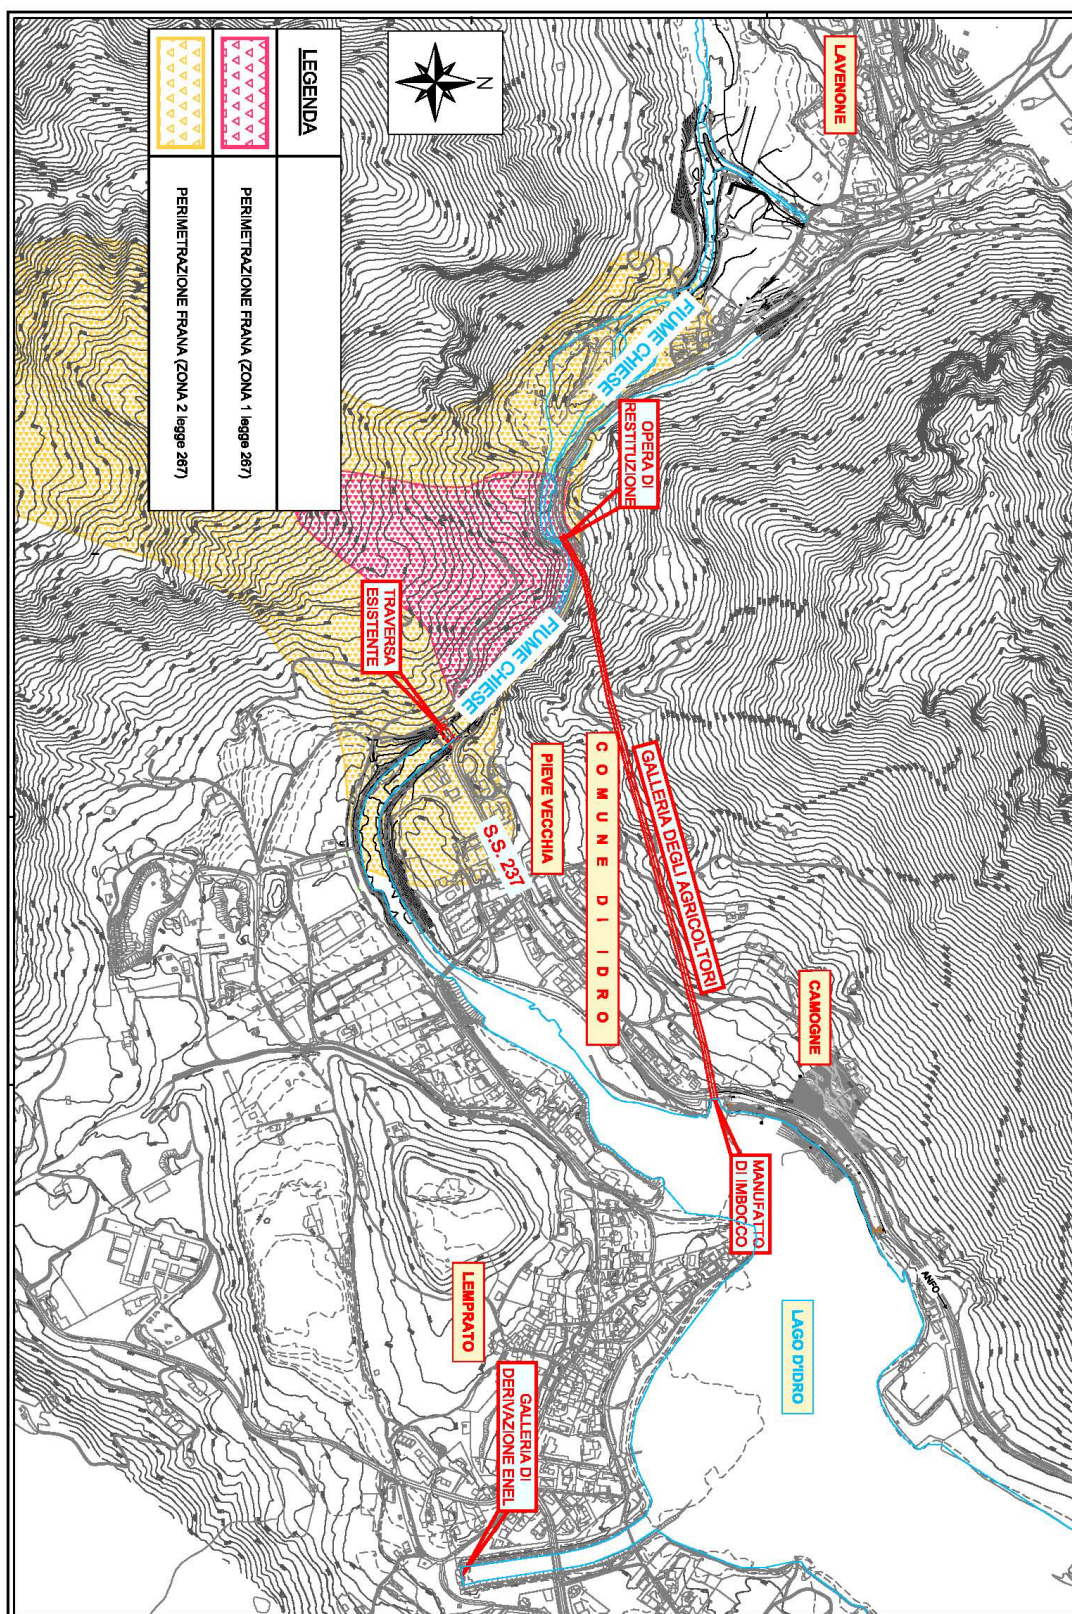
planimetria dello stato di fatto con perimetrazione del pendio in frana (legge 267/98: aree ad elevato rischio idrogeologico)
